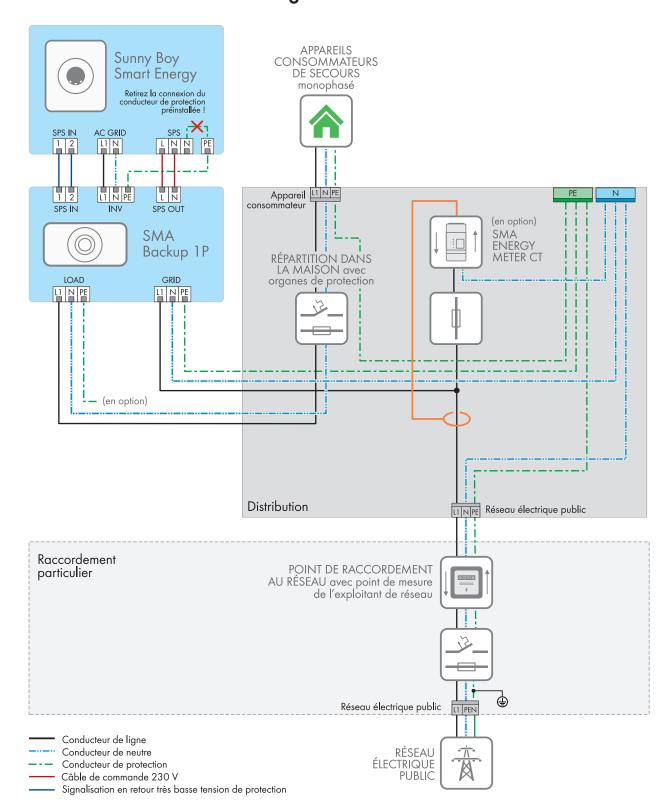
Vue d'ensemble du câblage SMA Backup 1P
